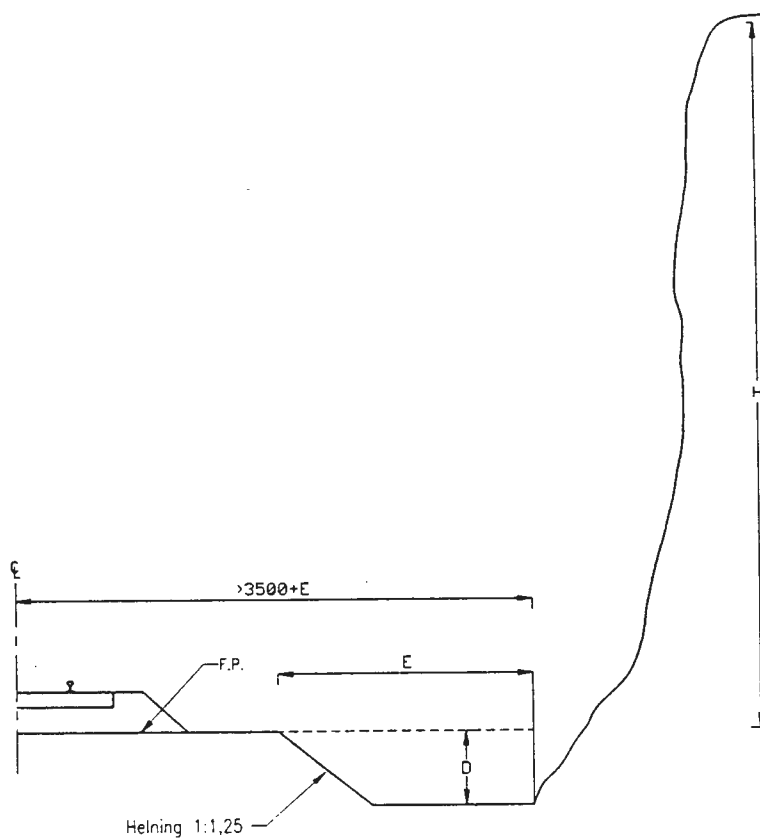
Planeringsprofil i fjellskjæring med åpen grøft.
